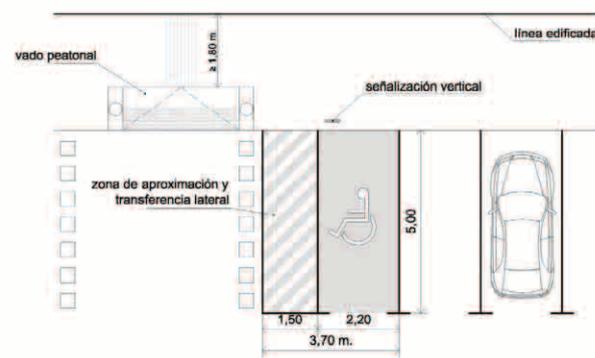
Aparcamiento en batería (fuente: Orden VVV/561/2010)
